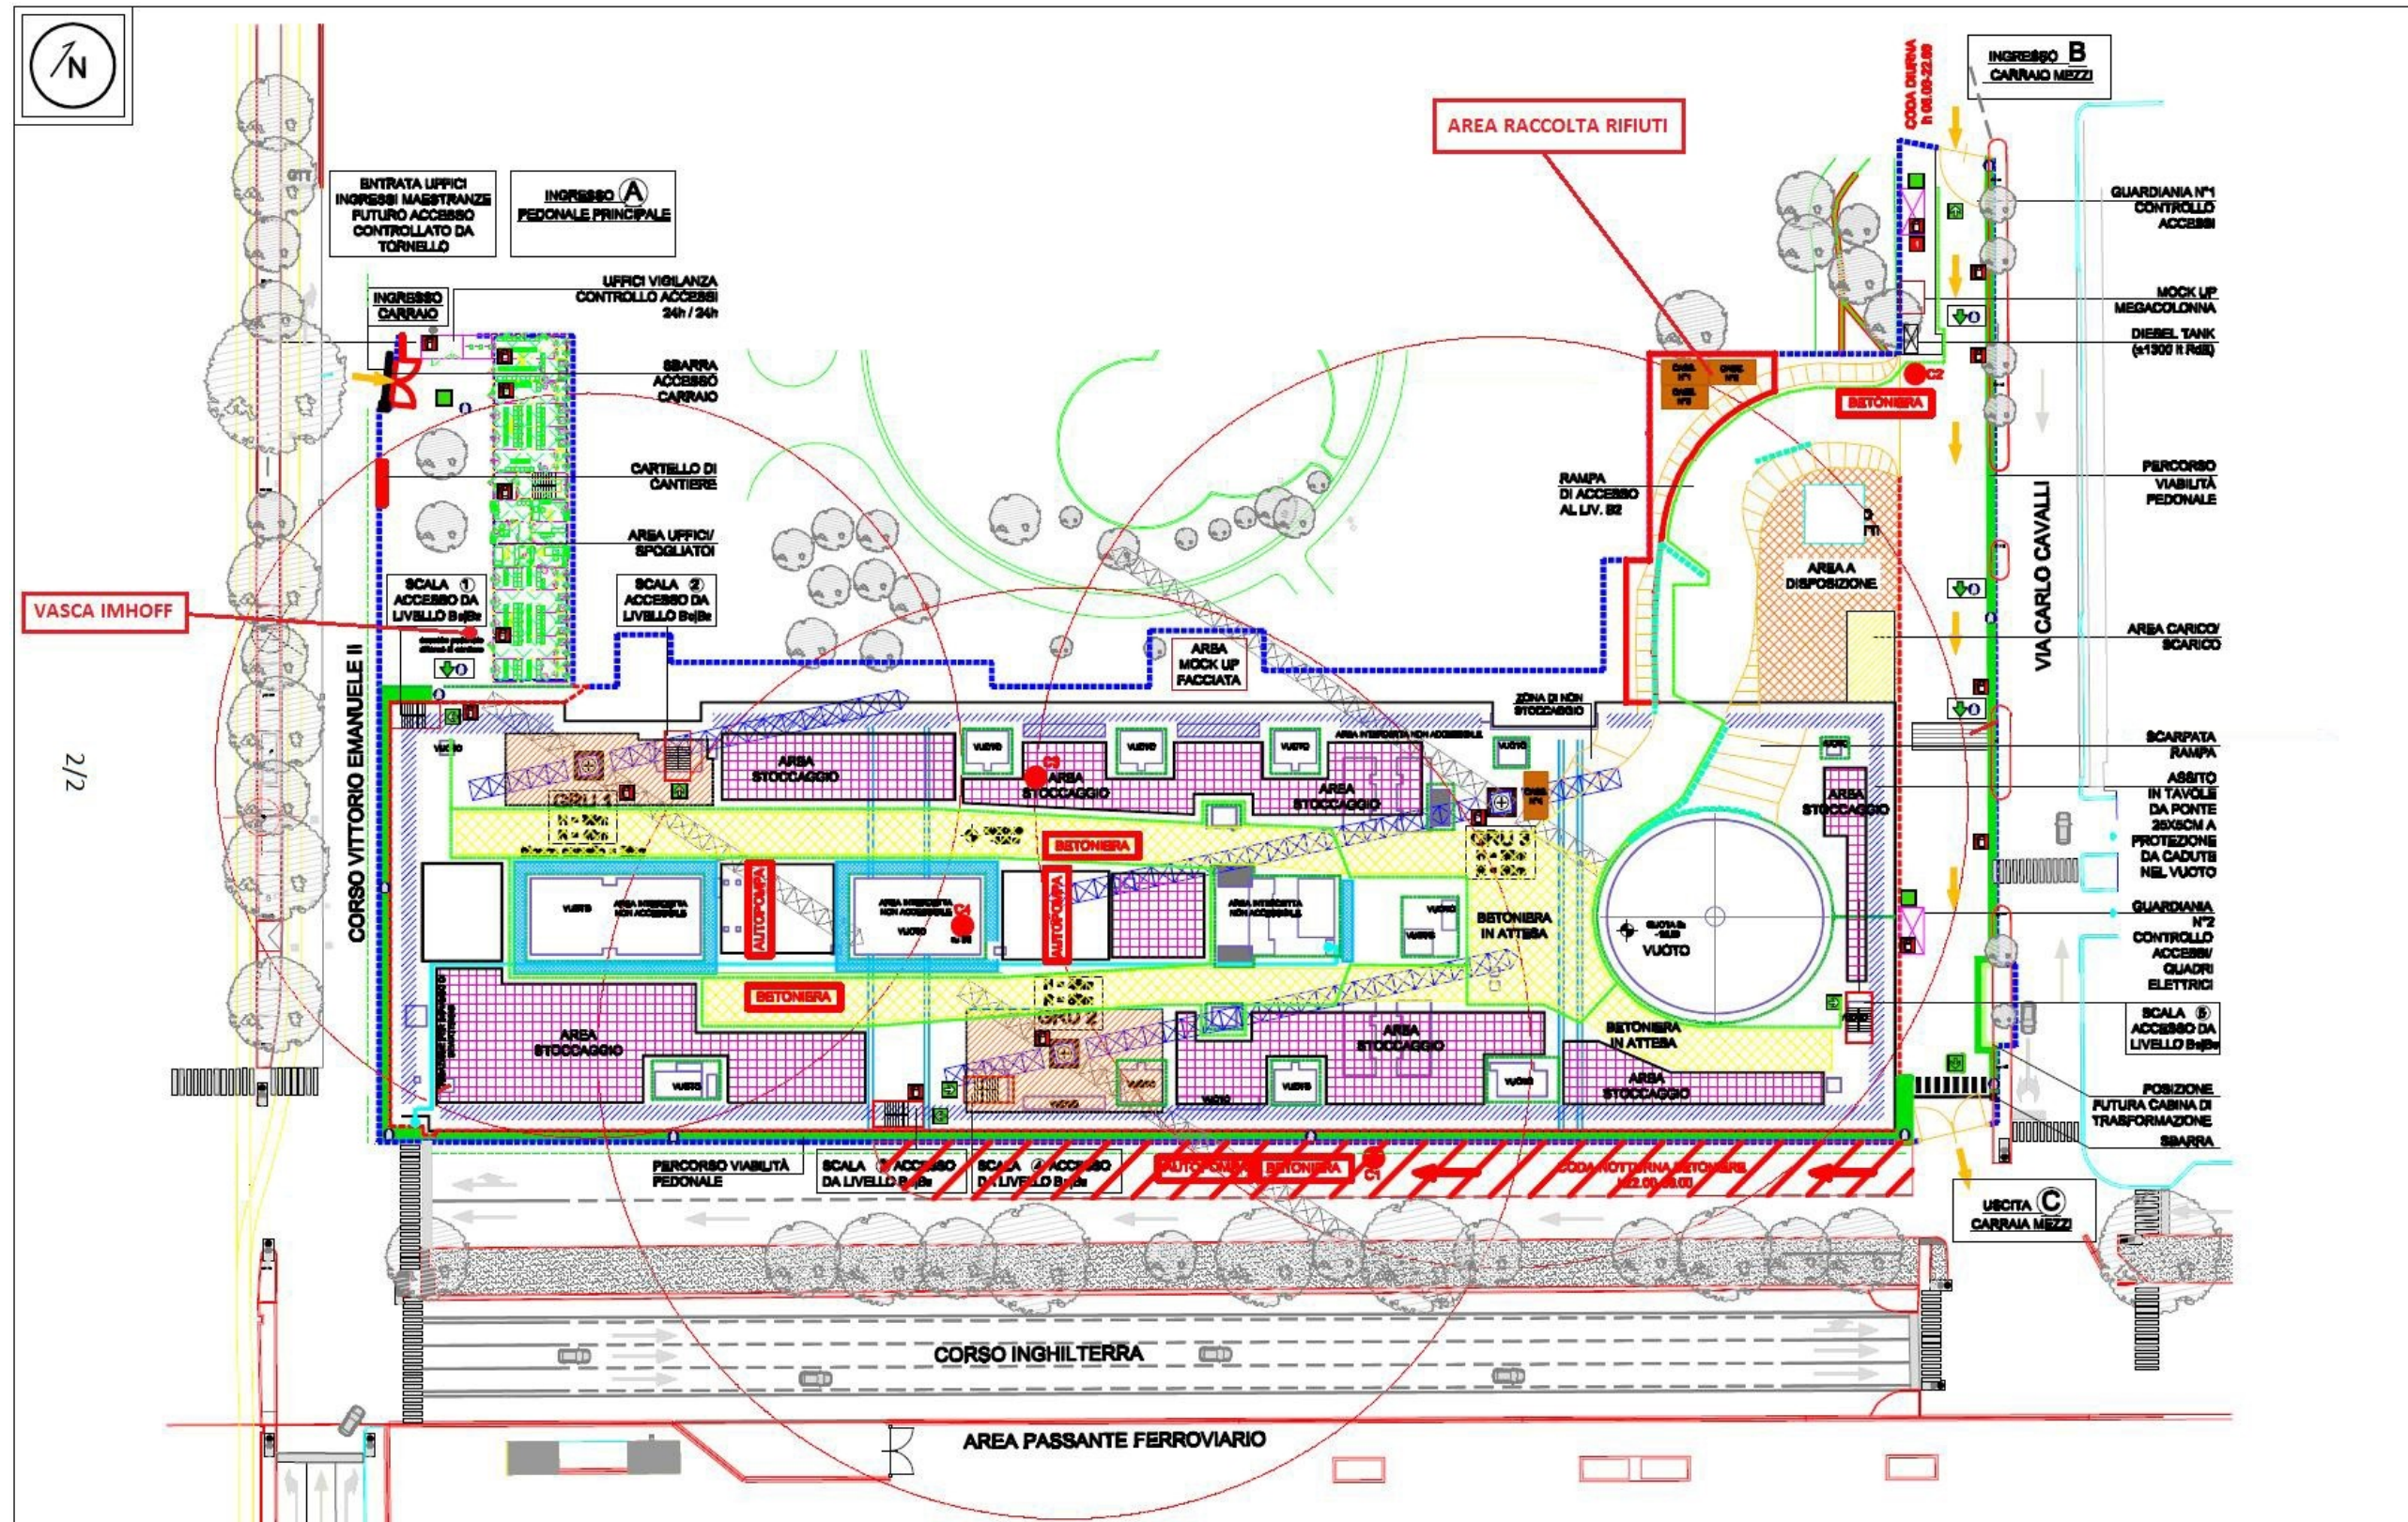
Planimetria di cantiere con indicazione dell'organizzazione interna per il conferimento rifiuti (Fonte: elaborazione Torre Scarl)
